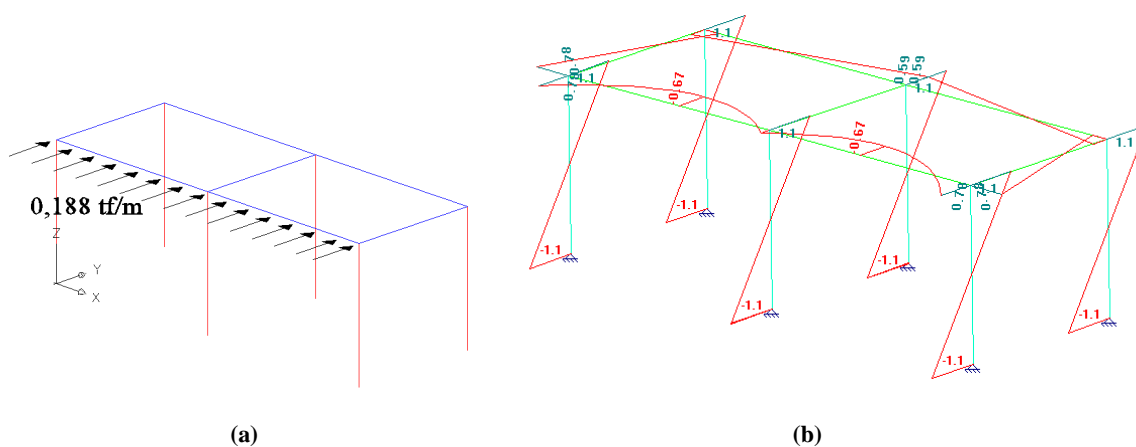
22 - Modelo 2: pórtico tridimensional em que as vigas possuem inércia transversal elevada. (a) Esquema de ações; (b) Momento fletor nos pilares e vigas de contorno.
